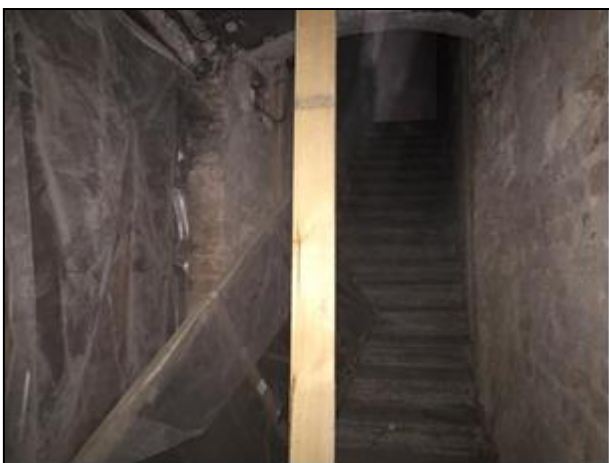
Общий вид оцениваемого помещения (вид в сторону здания лит. В)
